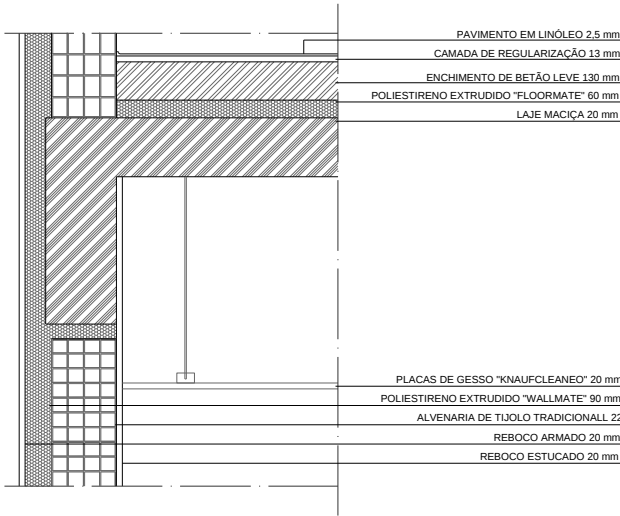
| Pormenor da ligação da laje com a parede exterior.
